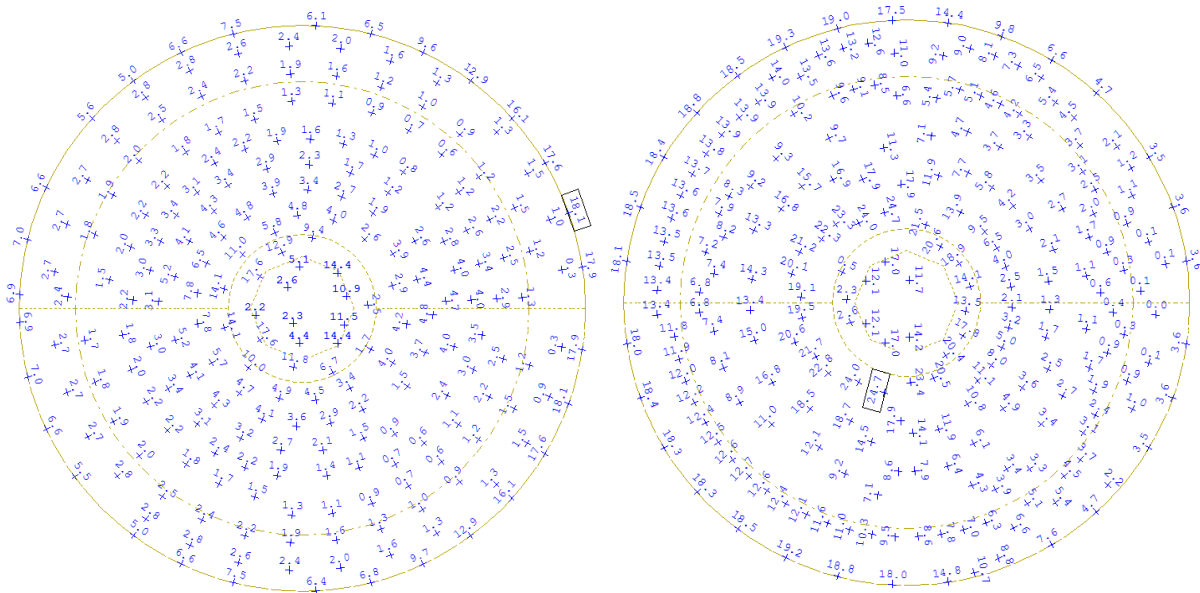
Bewehrung auf der Innenseite des Deckels (Draufsicht auf das Betonbucket; Extremlastfall 1 – Luvseitig, Fußpunkte eingespannt)
